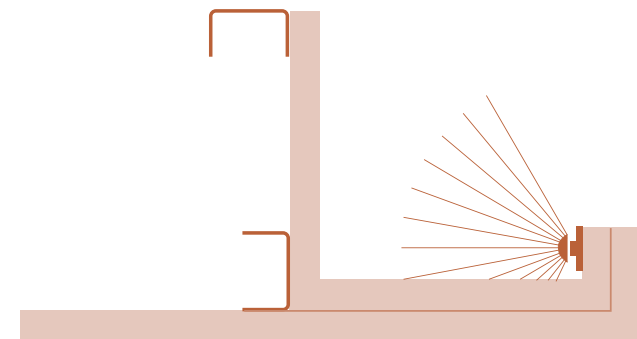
Detalle de cenefas | Fuente: Elaboración propia
